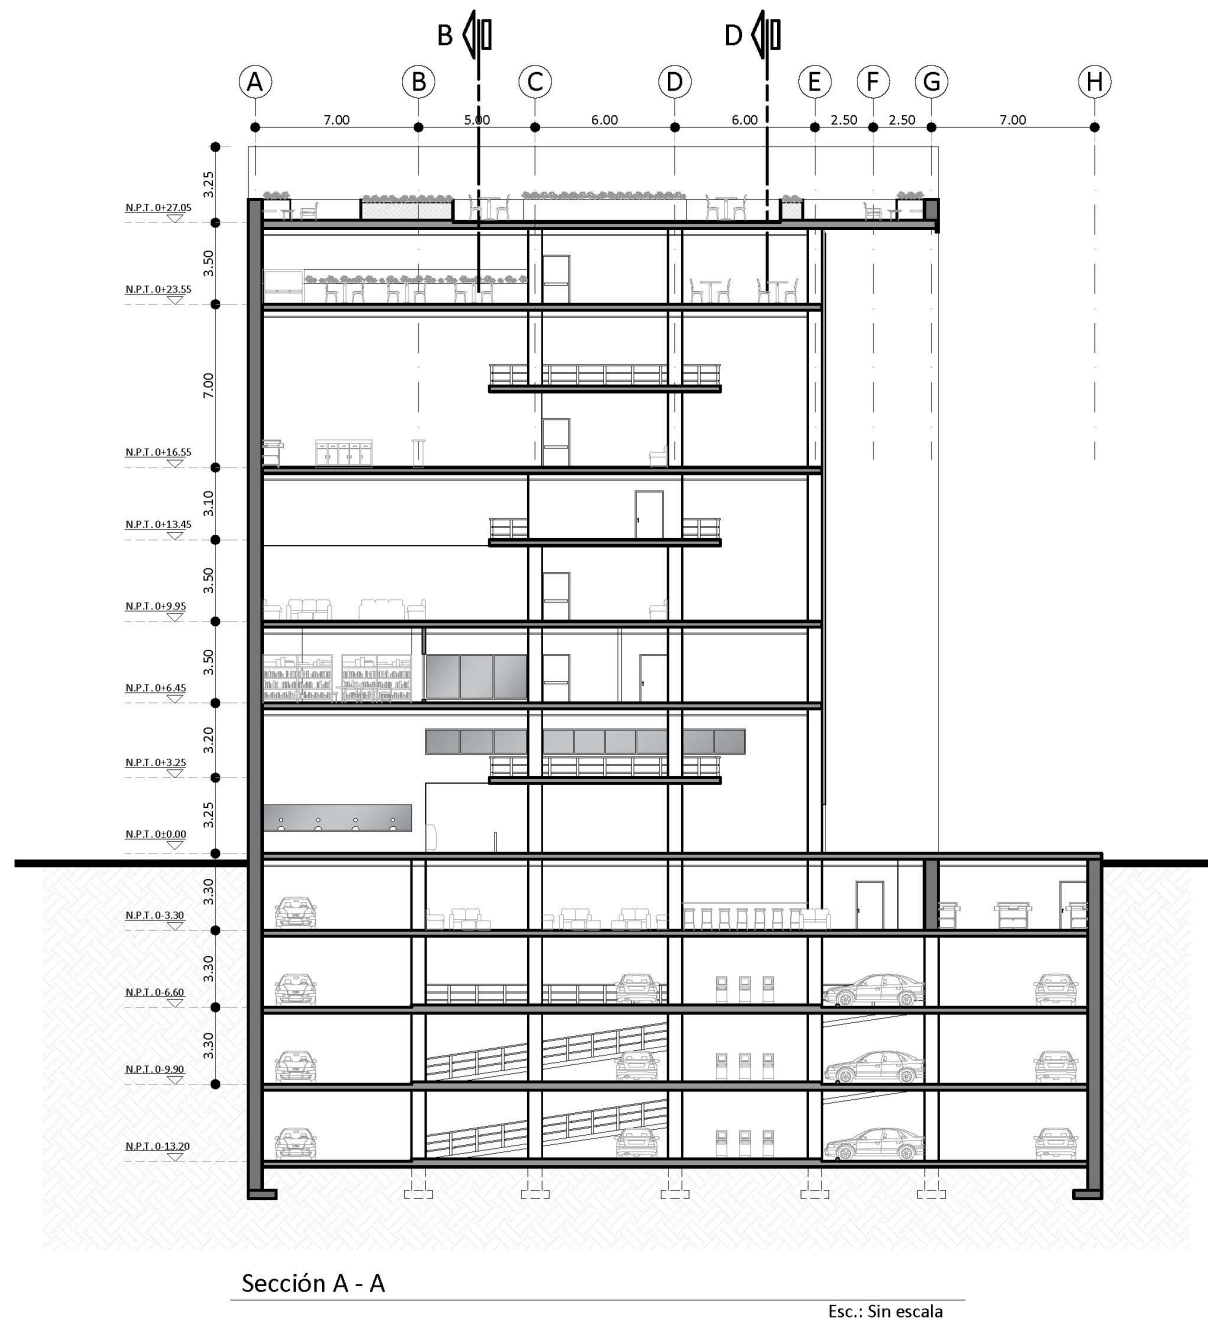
Sección arquitectónica A - A. Fuente: Propia.
